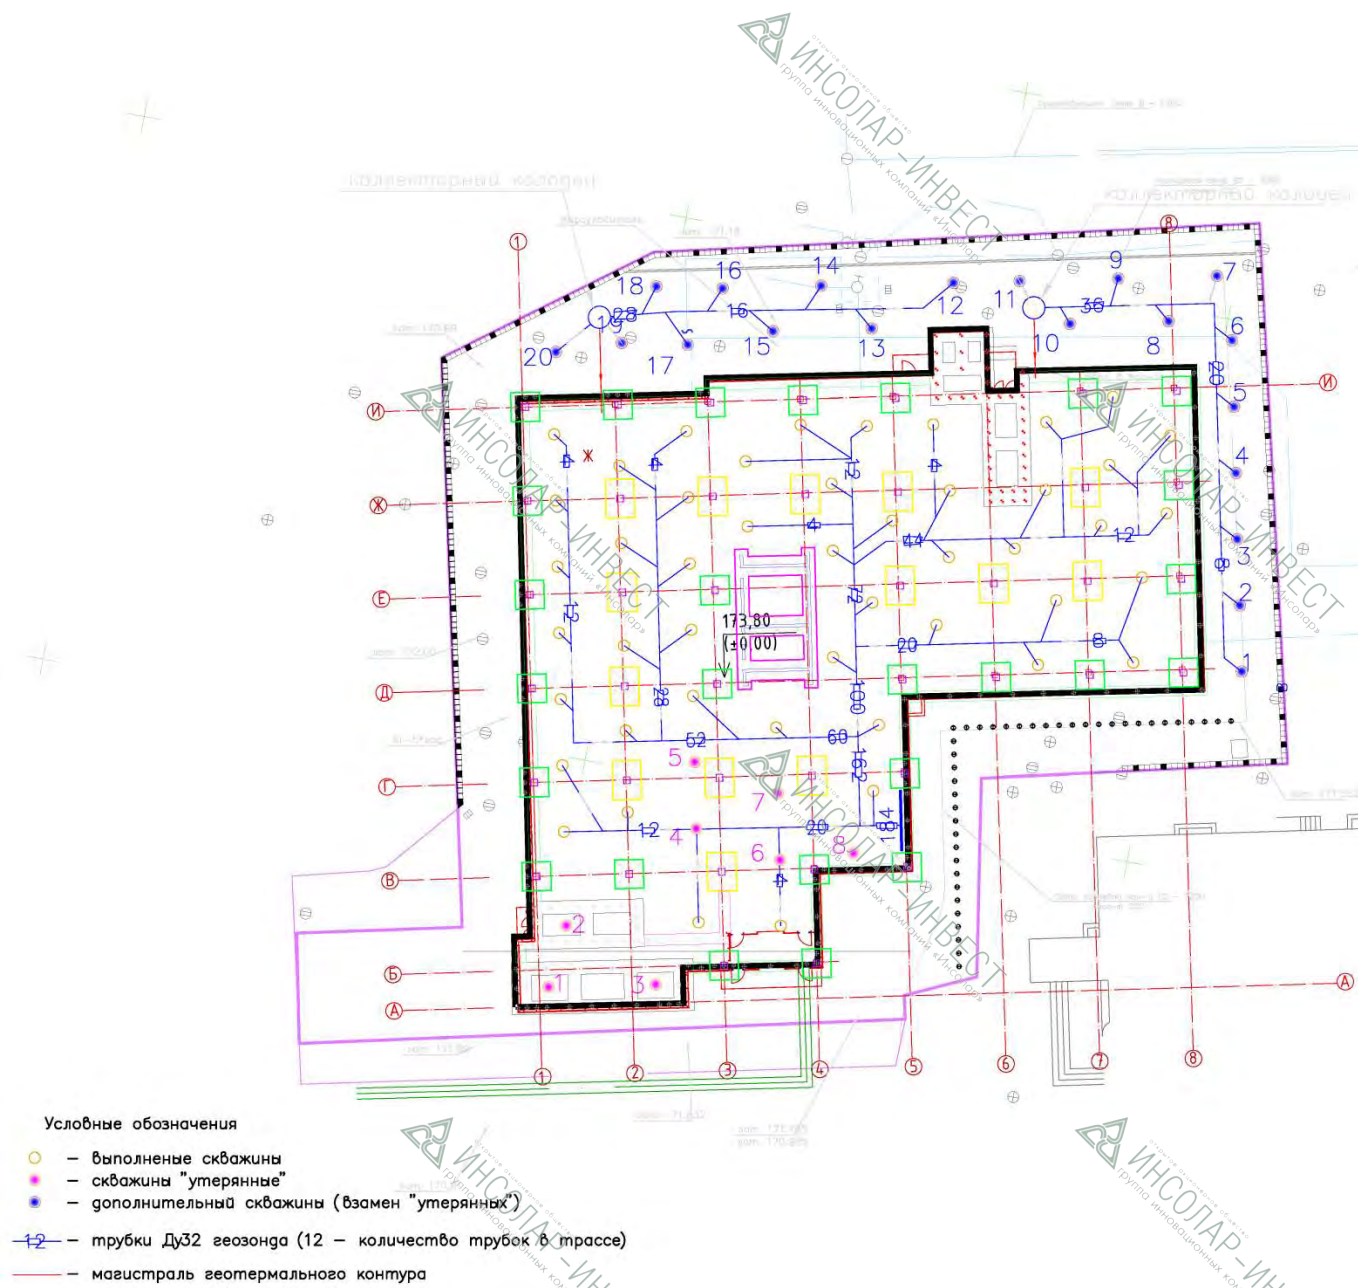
План размещения грунтовых теплообменников вблизи проектируемого здания.
